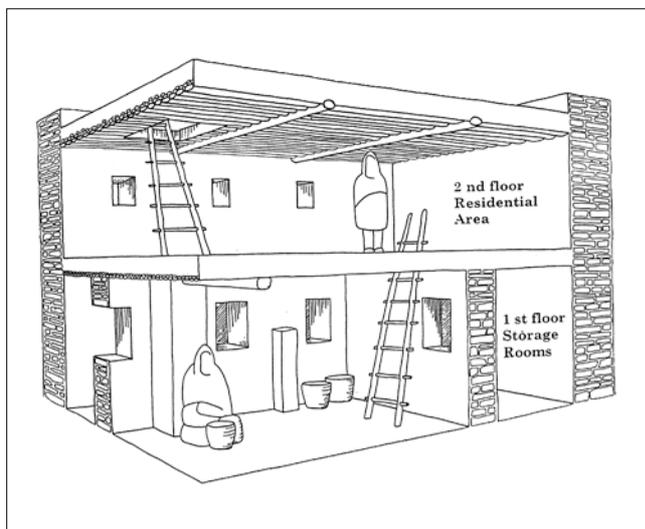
Basta – Rekonstruktionsversuch eines Gebäudes in Areal B (Kujit 2000:fig.8)
